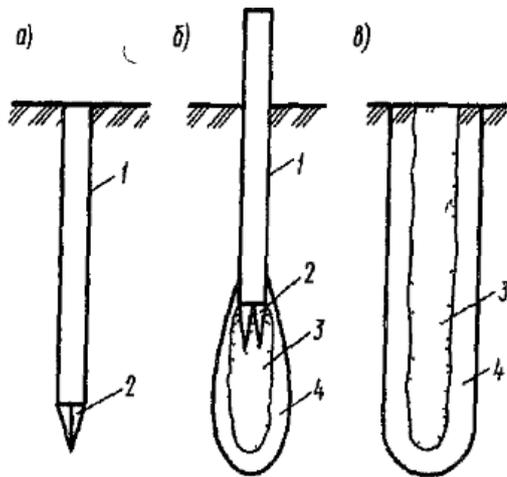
Схема устройства песчаных свай: а — погружение обсадной трубы; б — извлечение обсадной трубы и засыпка скважины песком; в — схема песчаной сваи; 1 — обсадная труба; 2 — самораскрывающийся наконечник; 3 — песчаная свая; 4 — зона уплотнения
